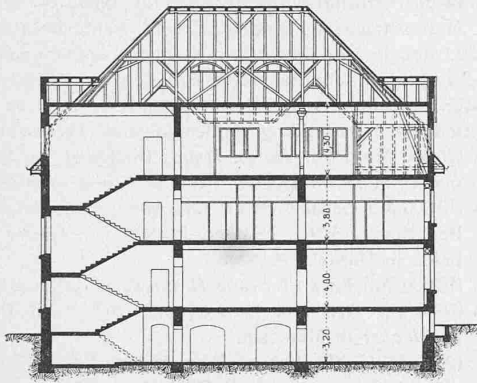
und 3. Schnitt und Grundrisse. — 1 : 400.
